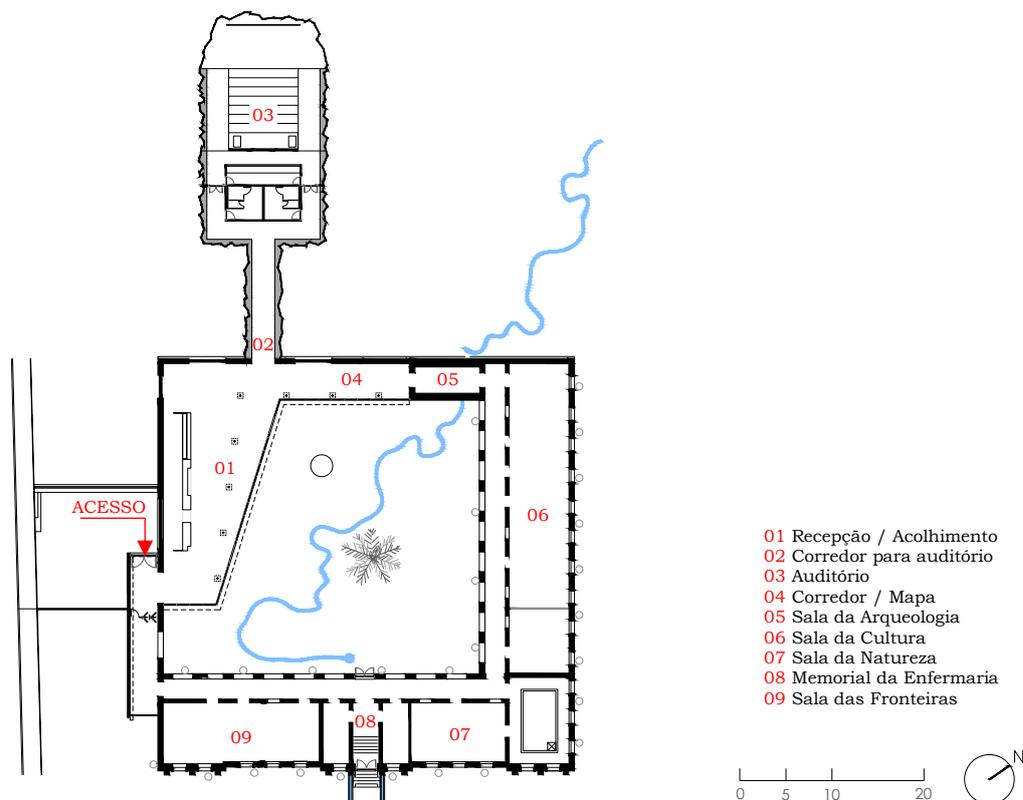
Planta baixa Centro de Interpretação do Pampa
